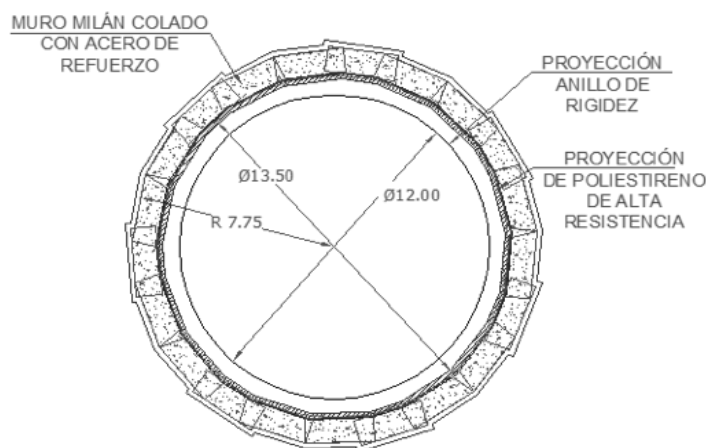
Construcción de lumbrera con muro Milán.⁵⁴
